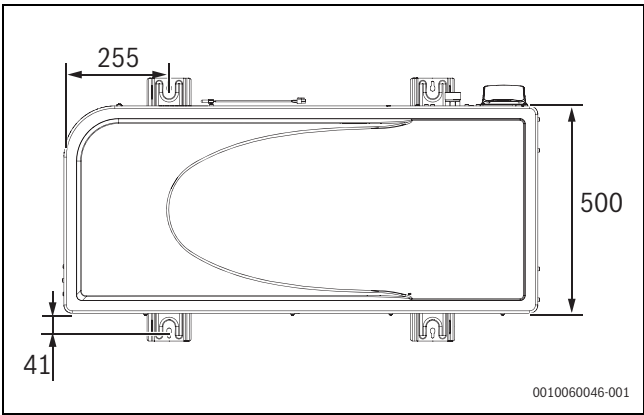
Abmessungen der Wärmepumpe, Draufsicht
